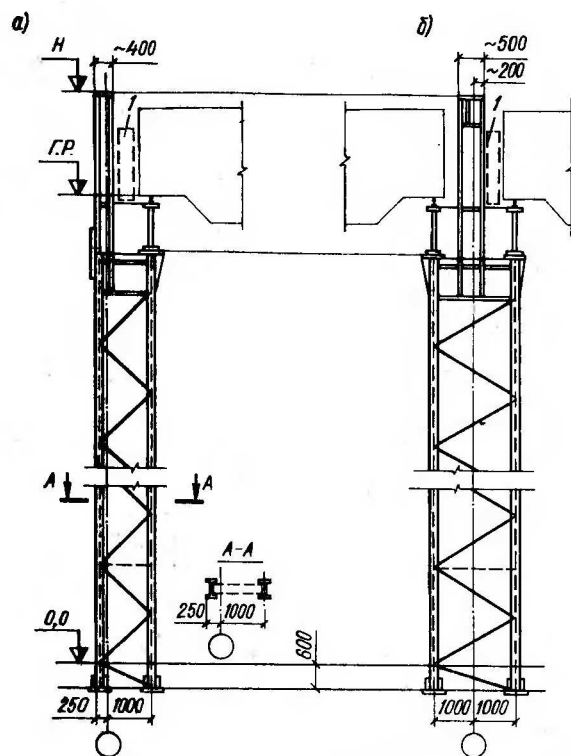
Колонны ступенчатого типа для крановых зданий с проходами, вдоль подкрановых путей
